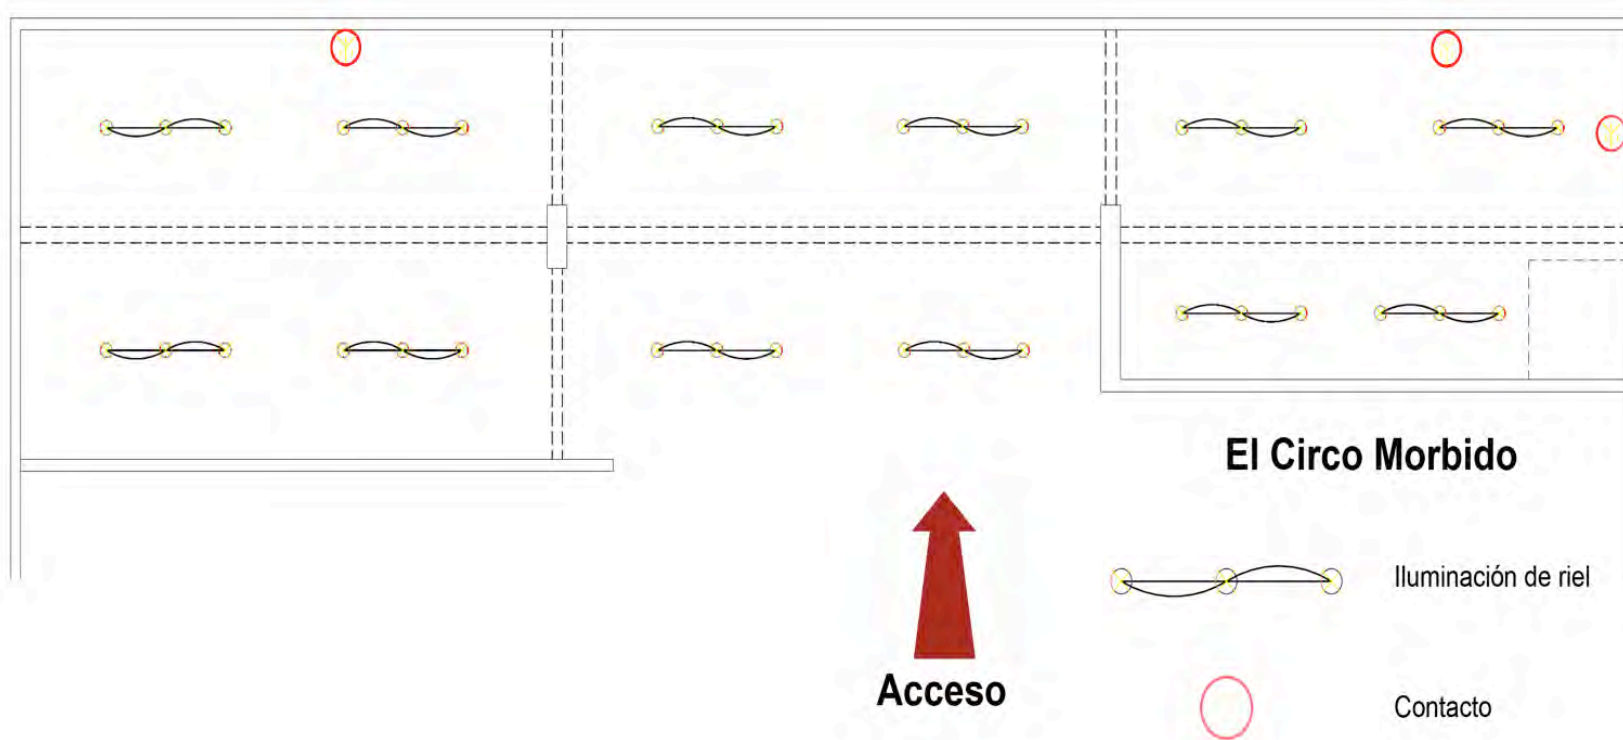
Planta arquitectónica con ubicación de luminarias.
